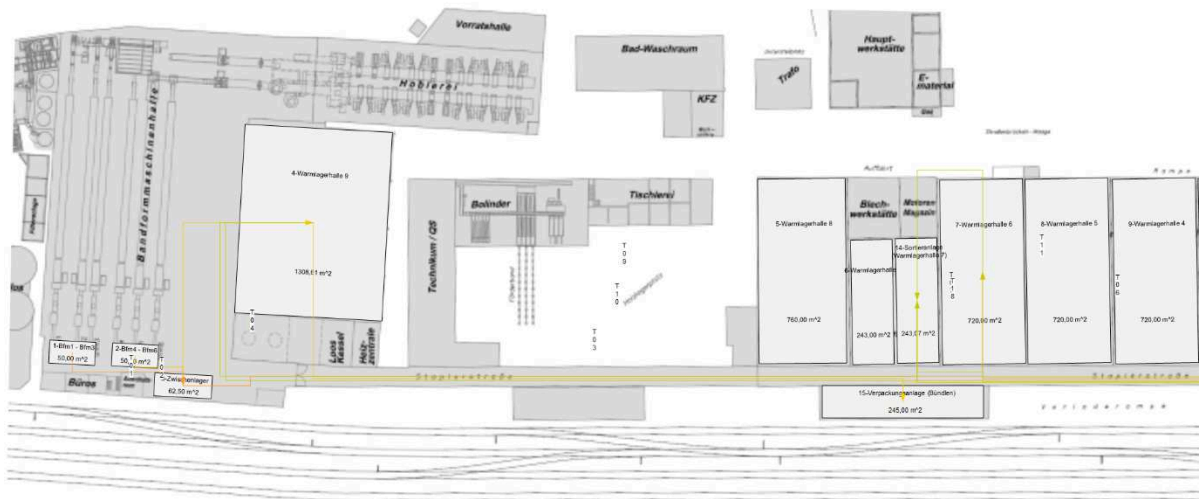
Grundriss Unternehmen 1 mit Transportwegen, Teil 1
